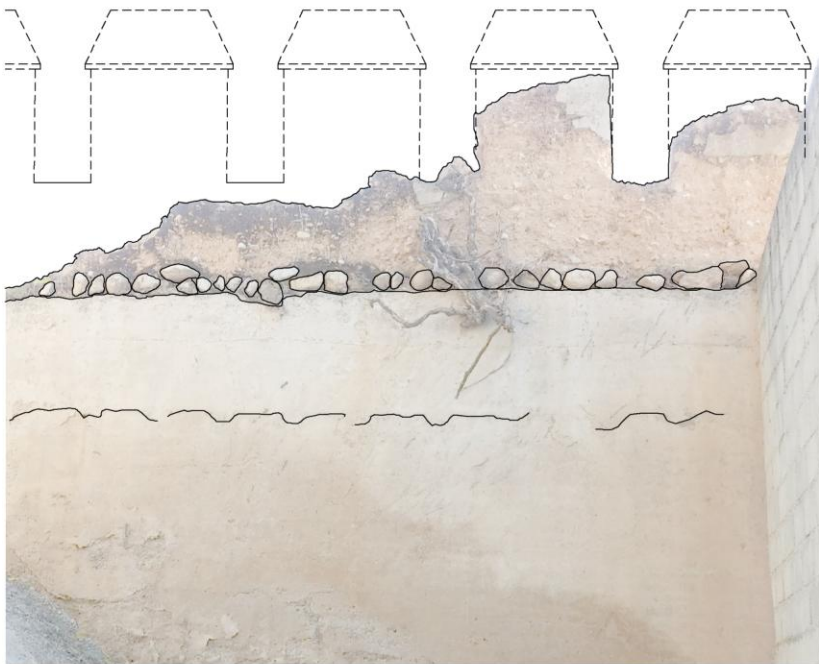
Detalle del pretil o parapeto en el sector 5 e hipótesis de perfil almenado
